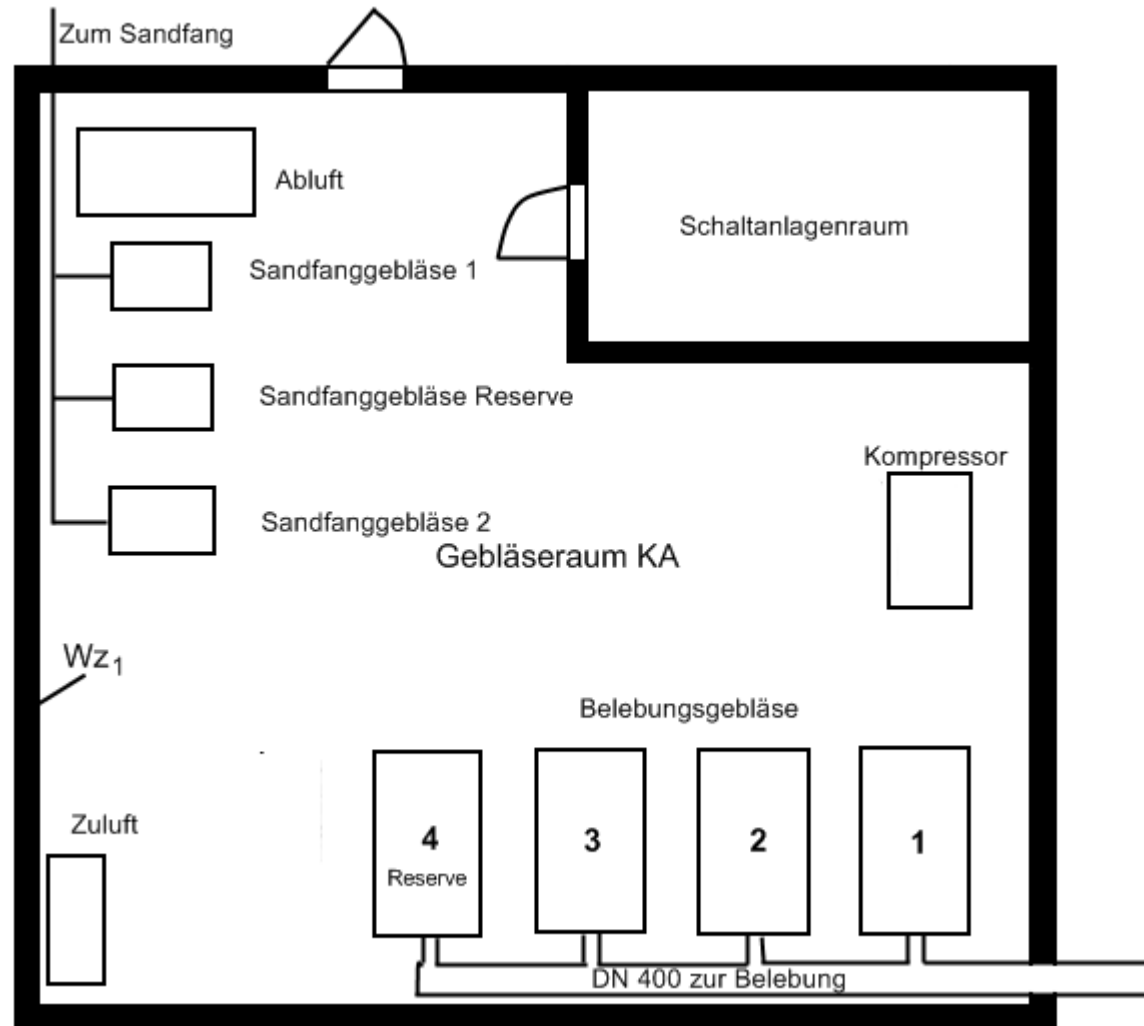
Grundriss Keller Gebläseraum
